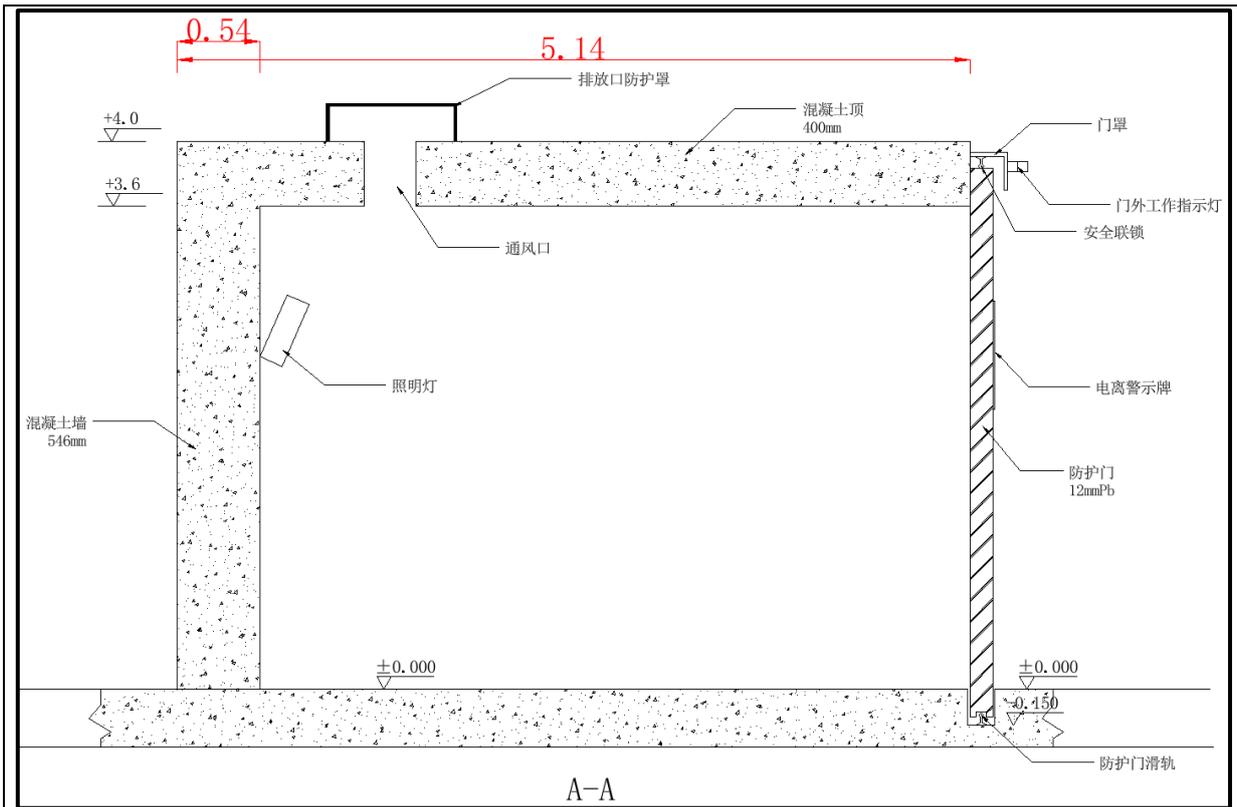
本项目探伤室辐射安全防护设施布置剖面图
